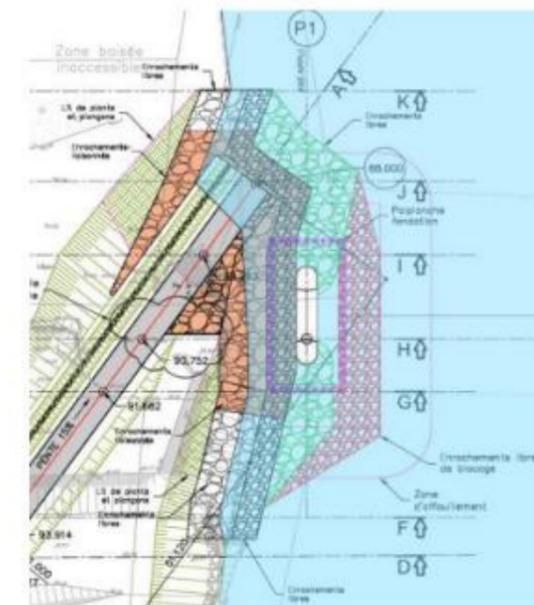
vue en plan de la protection (source : Étude de confortement des berges, Artelia – octobre 2024)
